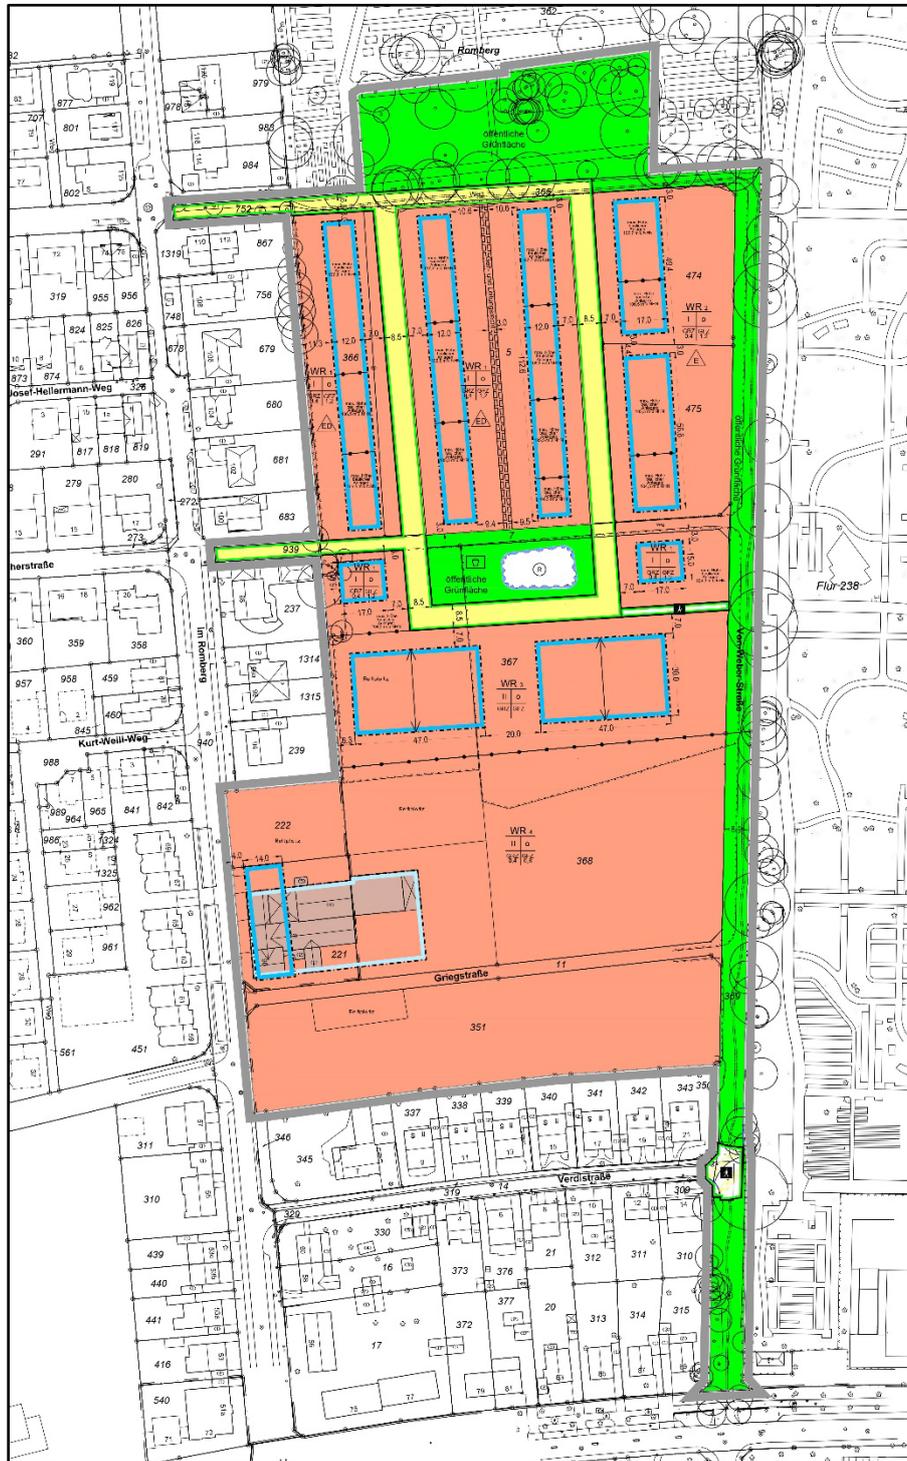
Bebauungsplanentwurf 262 – Griegstraße –
